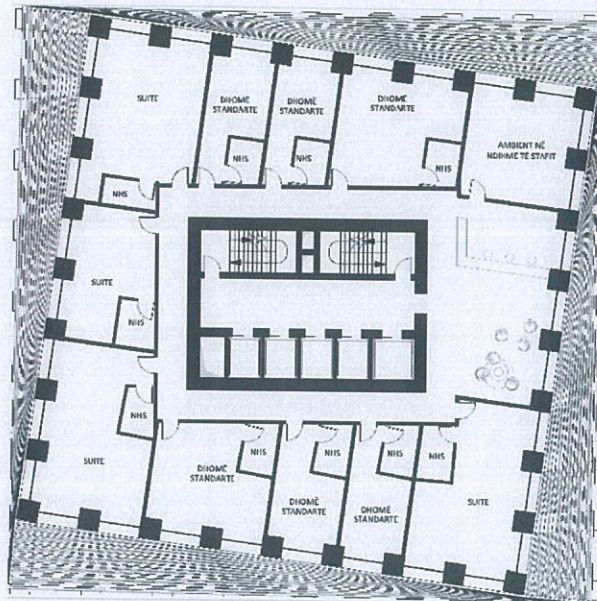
Planimetri e katit +19, në kuotën +75.6 (Skema e funksionit hotel, kati 15-24)
